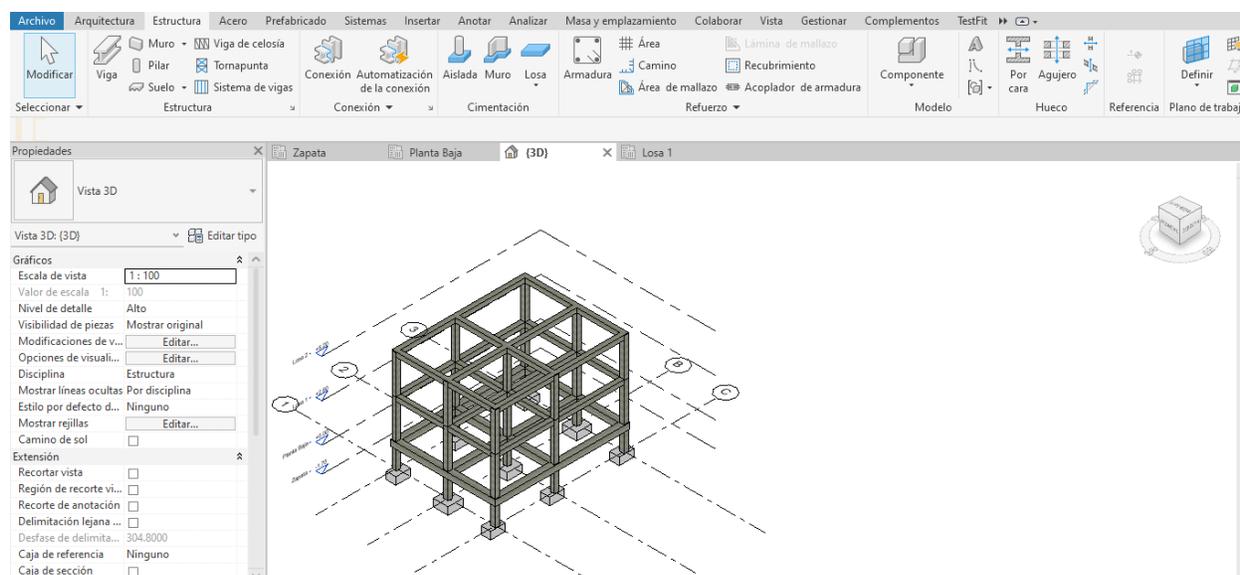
Vista en 3D de vigas y columnas en las 2 plantas
